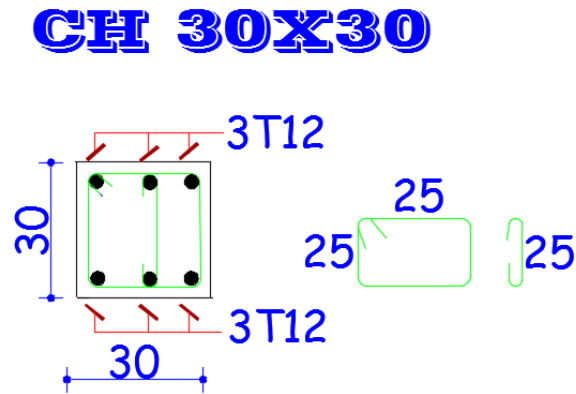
Schéma de ferrailage de la poutre de chaînage (30× 30).
